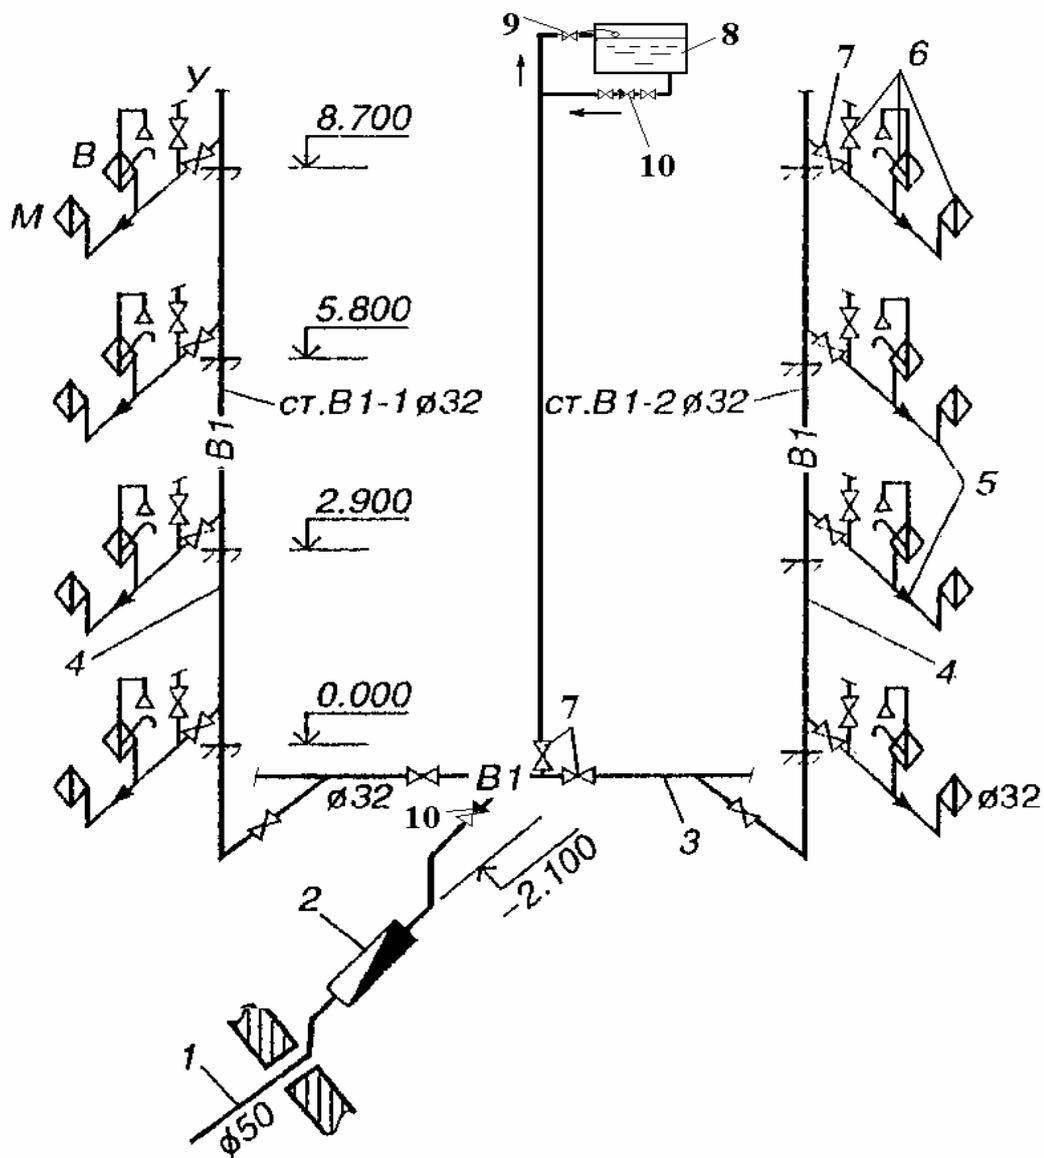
Схема внутреннего водопровода с водонапорным баком.
